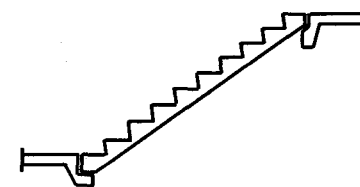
К задаче 4.1. Опираие лестничного марша на лестничные площадки
